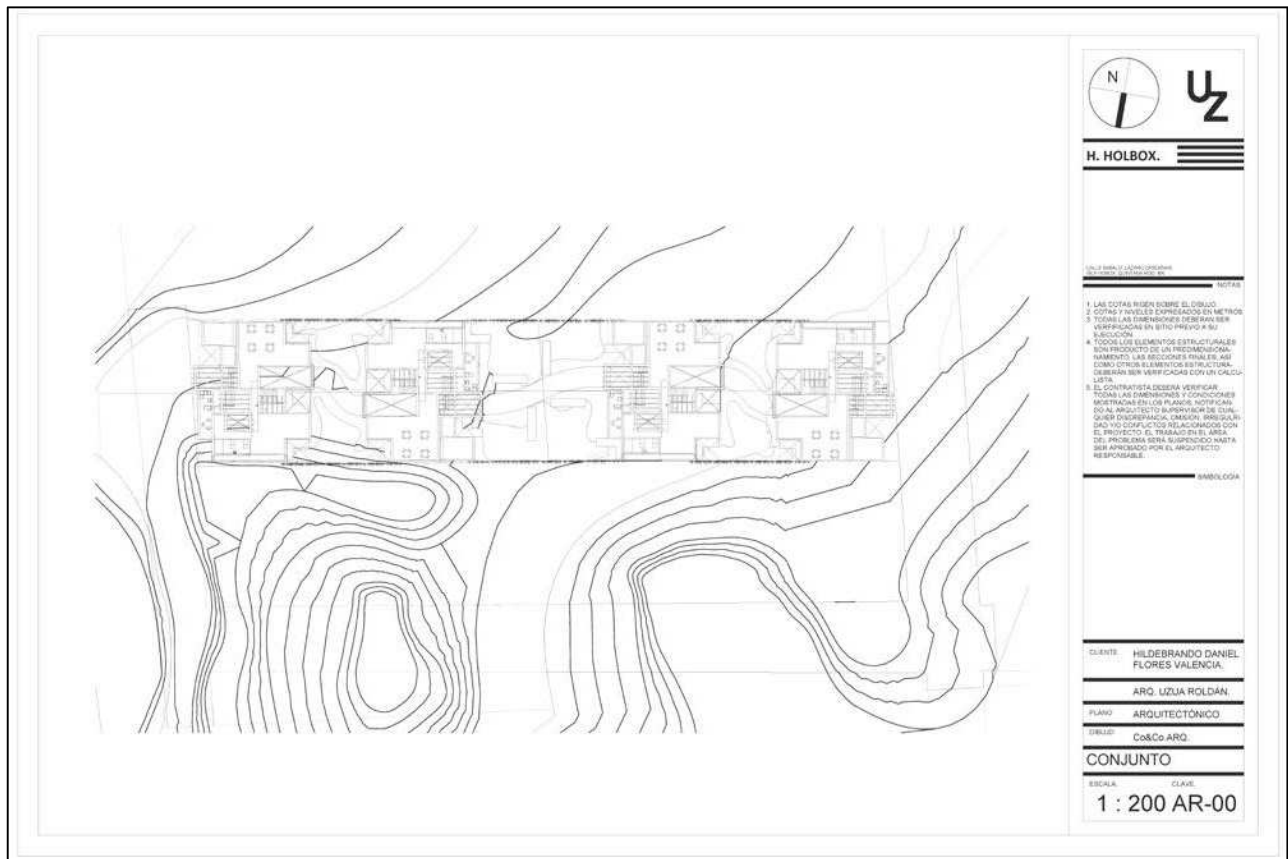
plantado del proyecto final en los predios considerados para llevar acabo el proyecto Villas Holx.
